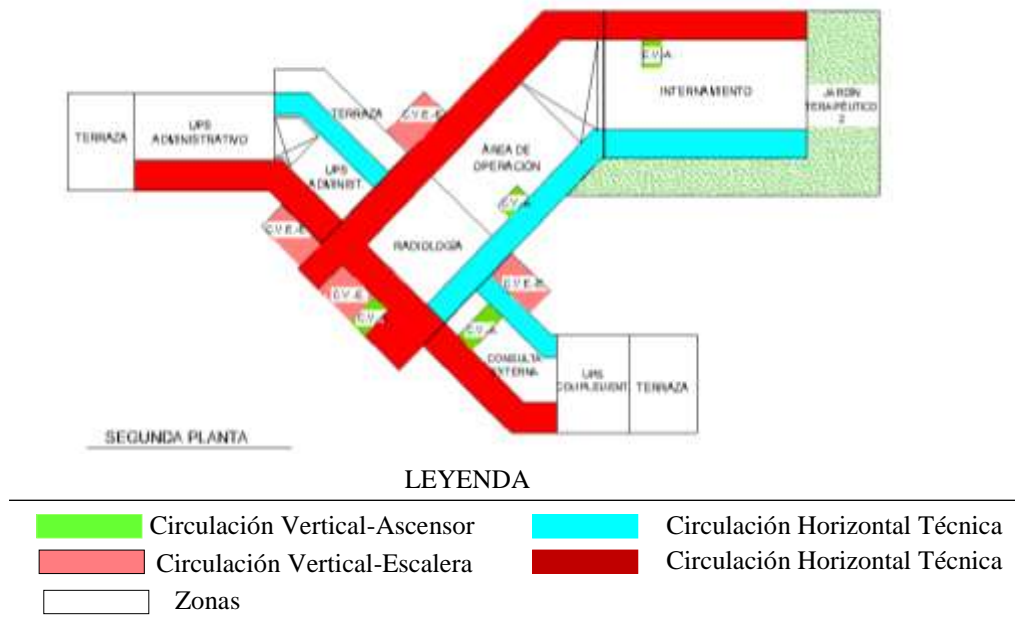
Zonificación-Segunda Planta de la Propuesta Arquitectónica.
